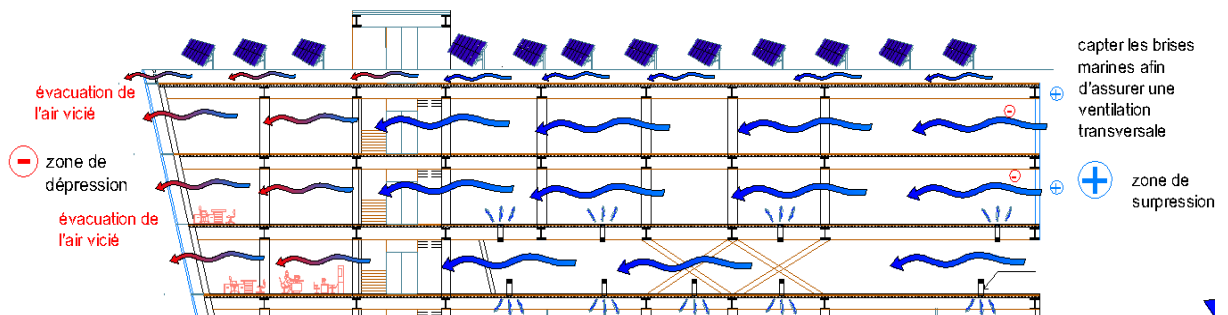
zoom sur la ventilation traversante coupe A-A. Source : auteurs
